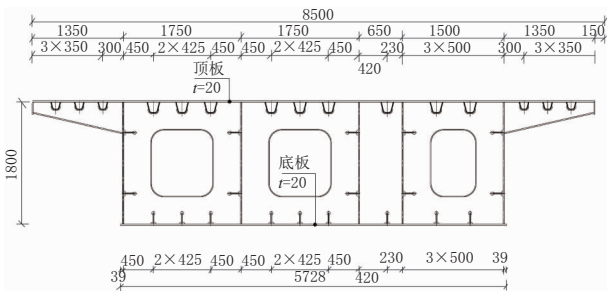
钢箱梁结构标准横断面示意图(单位:mm)
